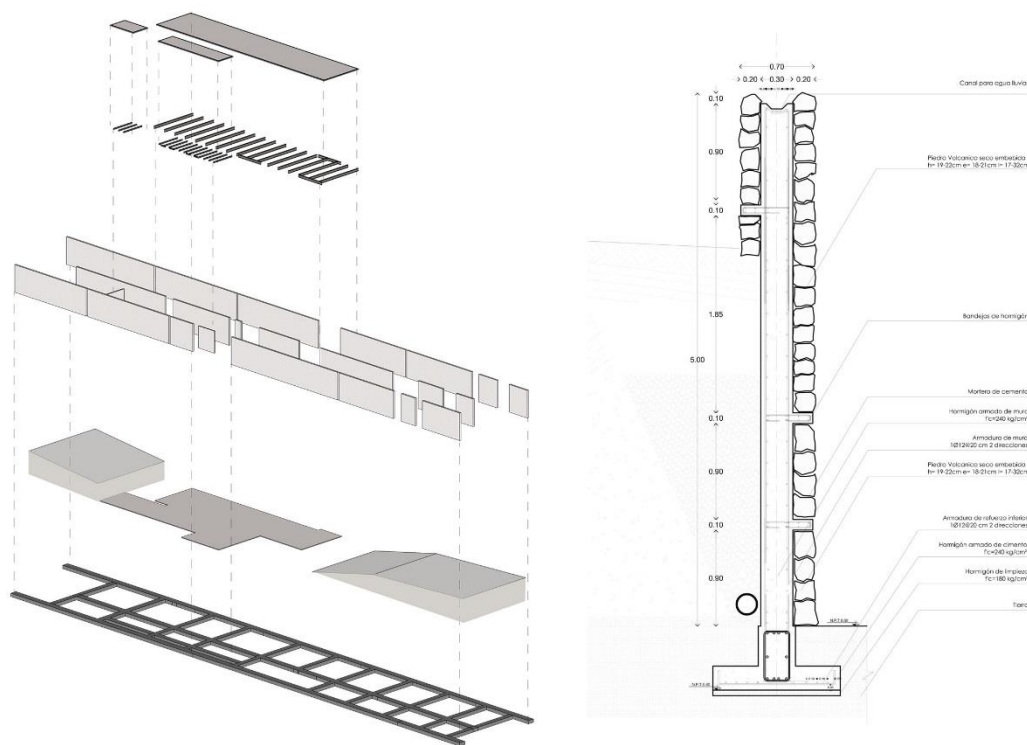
3D Estructural y detalle de muro. (Vasco, 2018)
